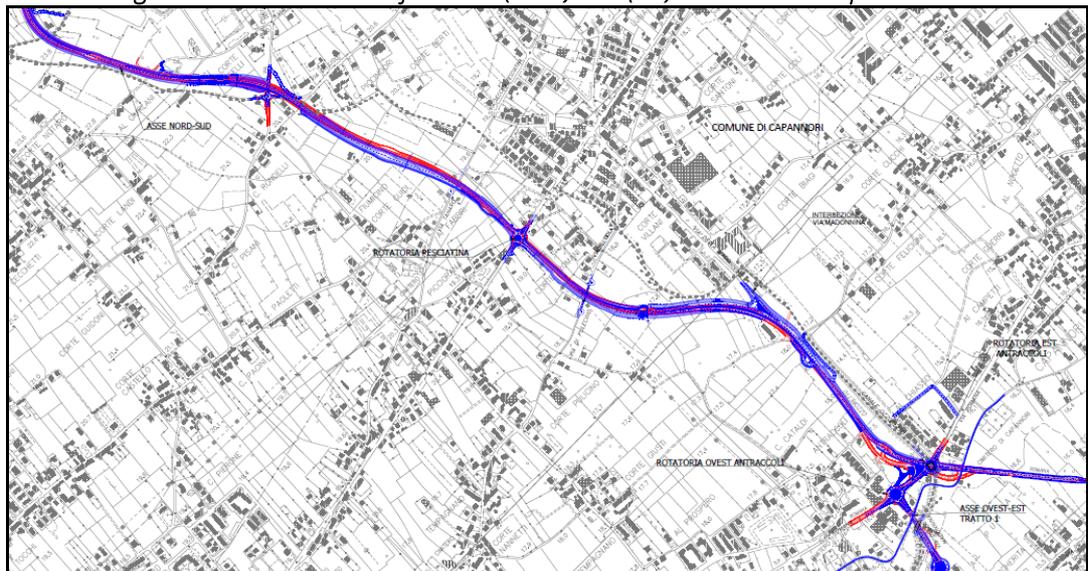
Planimetria di confronto PP (rosso) - PD (blu) - Asse Nord-Sud secondo tratto
